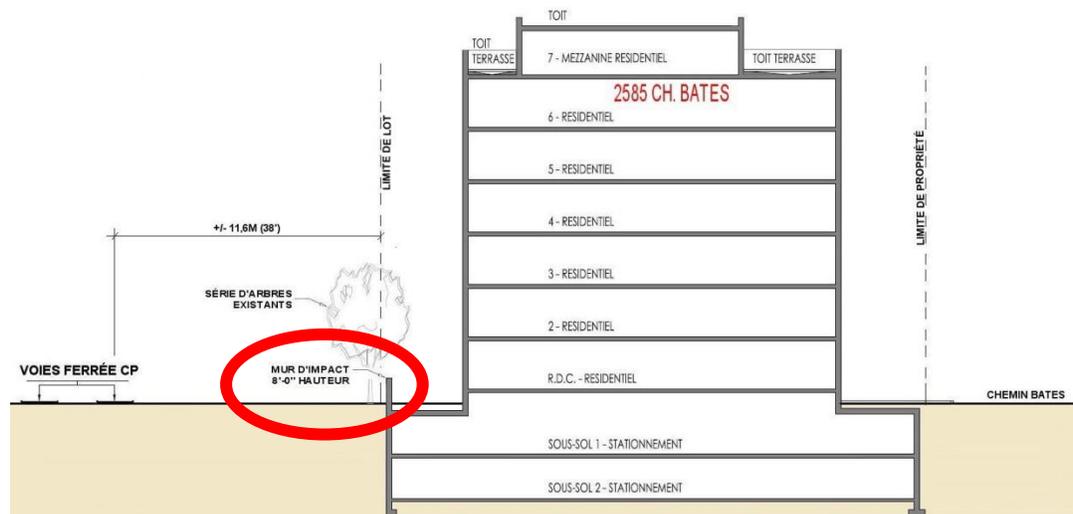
Mur d'impact de 2,44 mètres (8'-0") min. de hauteur en béton armé.
